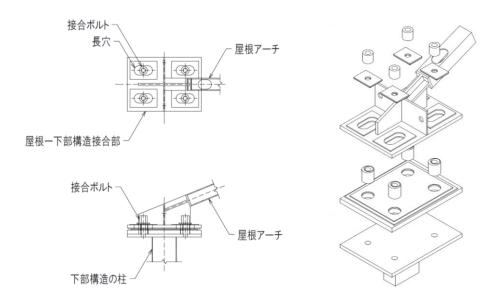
屋根と下部構造の接合部(左上:平面図、左下:立面図、右:構成図)
